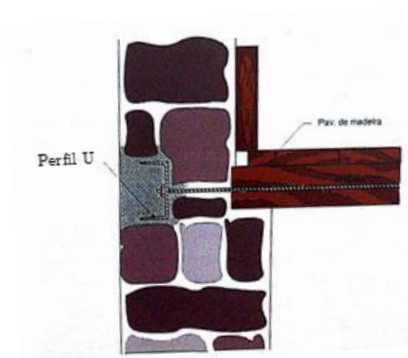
Colocação de tirante ao nível do pavimento. [27]
